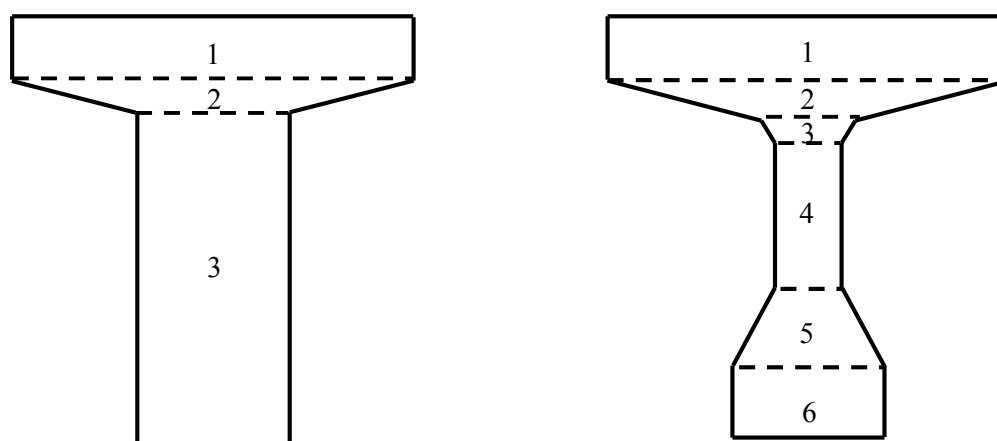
les sections de la poutre (d'about et mi travée).
